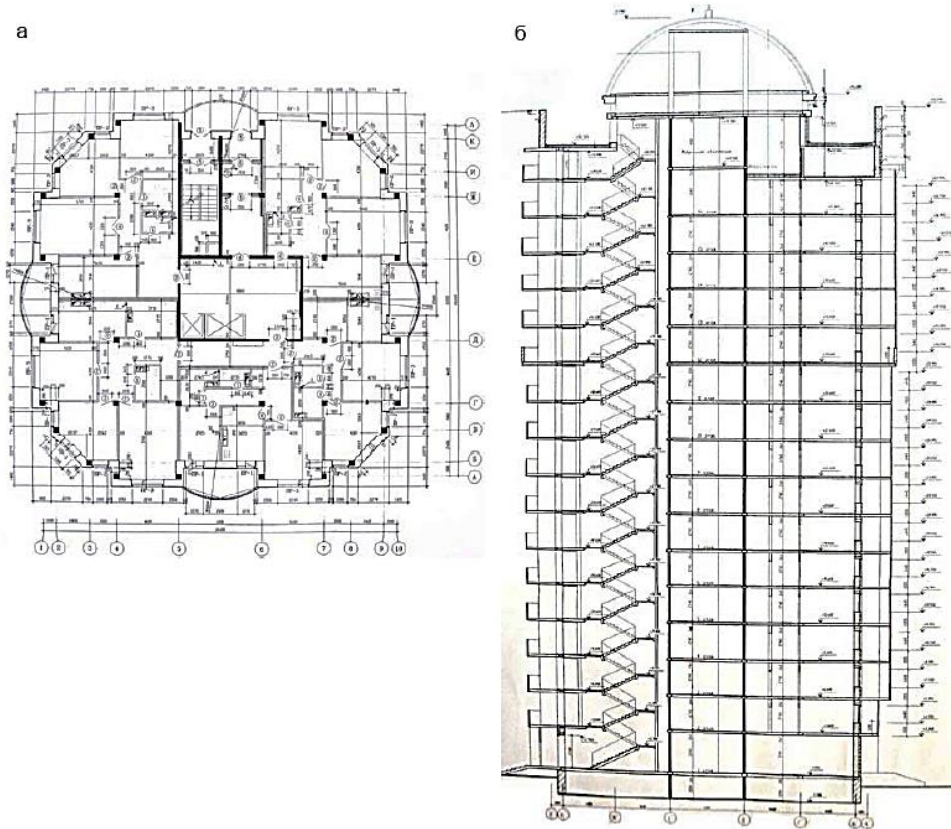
Схематичные план типового этажа и разрез рассчитываемого 16-этажного жилого дома
